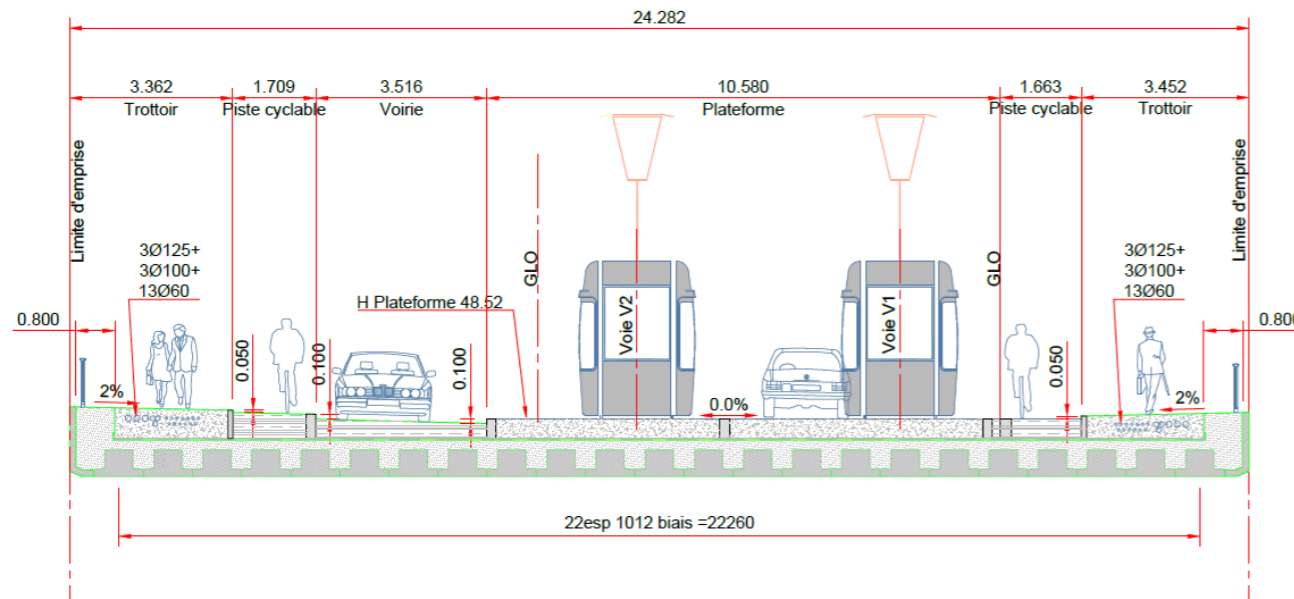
coupe transversale fonctionnelle sur ouvrage
